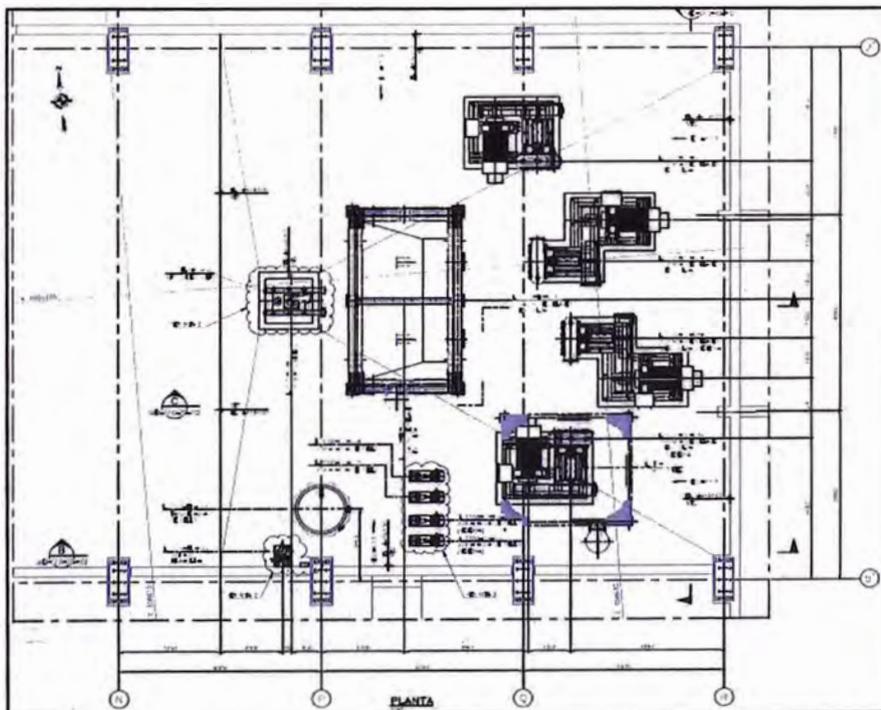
Plano en Planta de la zona Golder –nuevo alcance del proyecto
